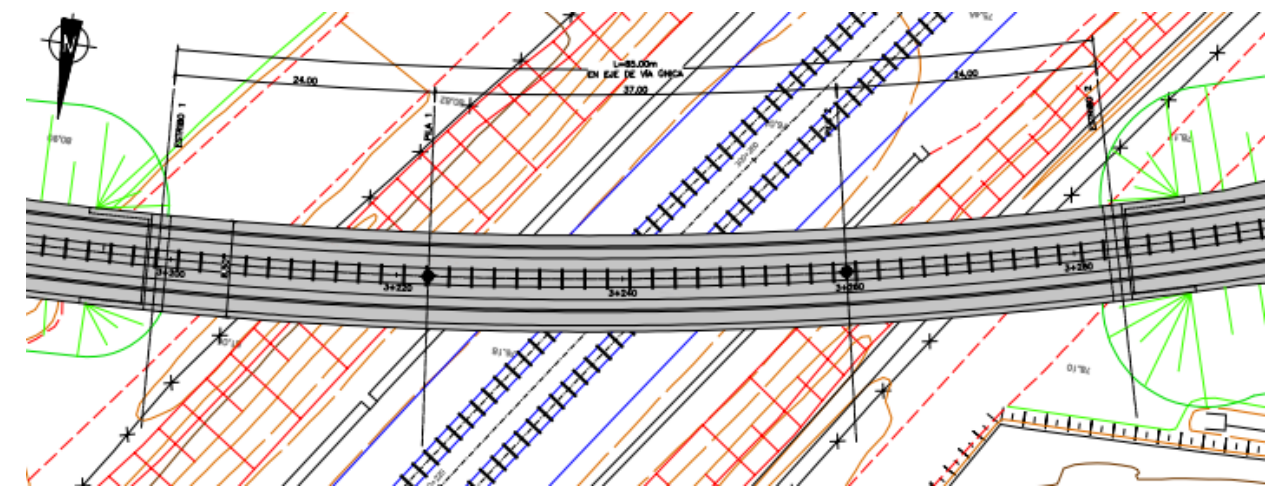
PLANTA VIADUCTO SOBRE PLATAFORMA LAV P.K. 3+240
